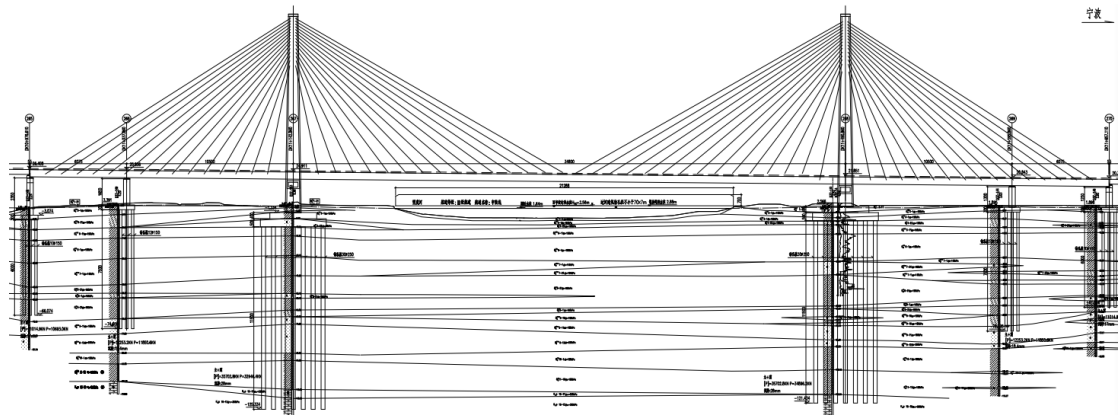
望虞河大桥主桥总体布置图（单位：m）
